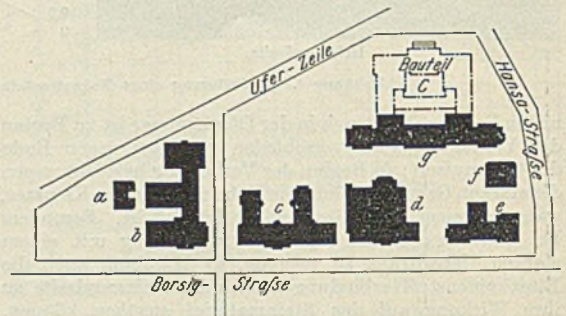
Lageplan der Technischen Hochschule zu Breslau.
